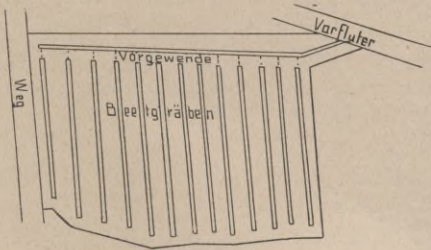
Lageplan einer Ringauschen Moordammkultur.
